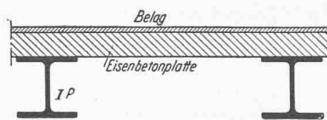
Schwere Decke aus Walzträgern und Eisenbetonplatte
